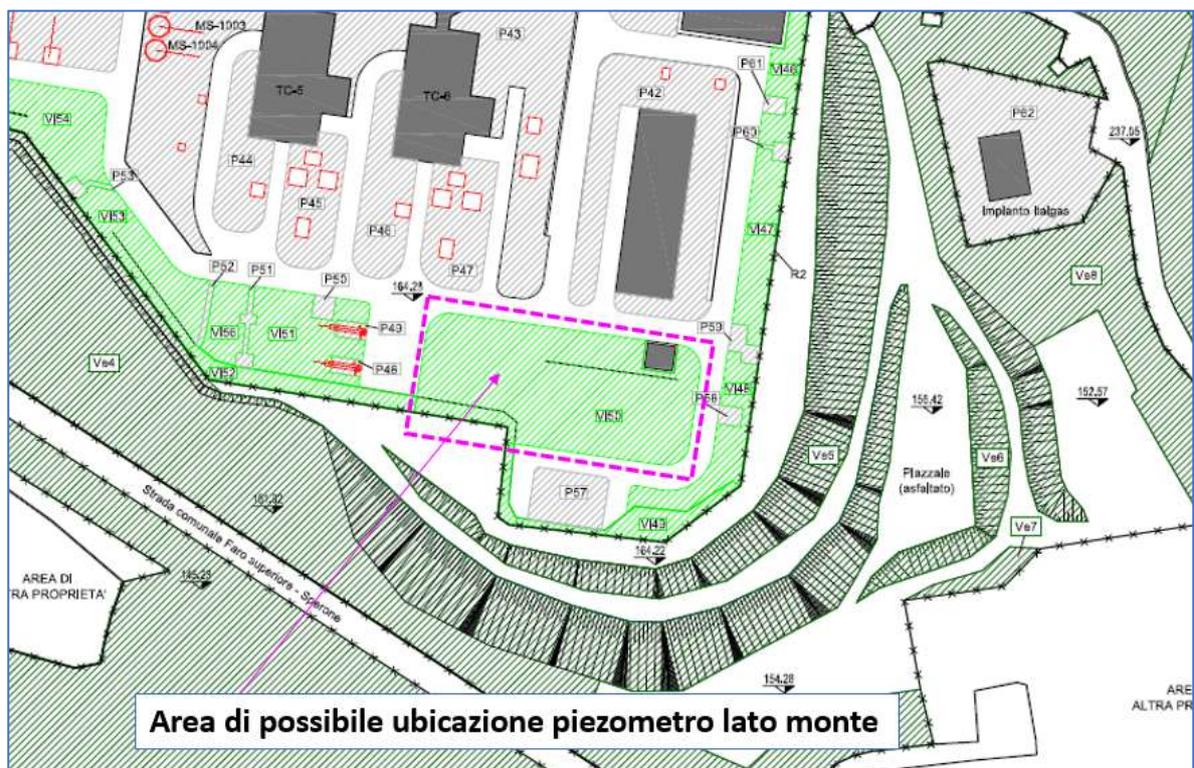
Ubicazione piezometro n. 1 'lato monte' su planimetria stato di fatto con aree a verde e pavimentate DS-501-PG-01 (anno 2018)
